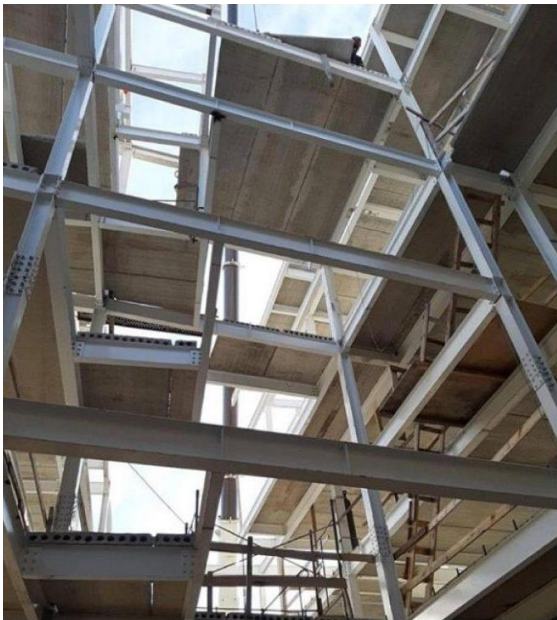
Sistema de construcción mixto. Fuente: Sistema constructivo mixto - ARQA Empresas
